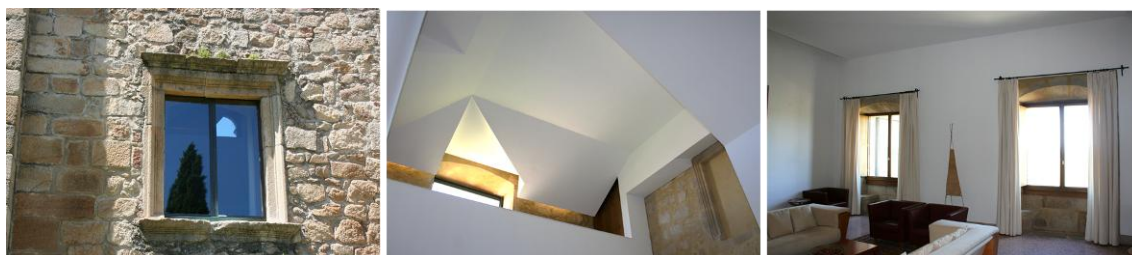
Pormenores de uma janela, do teto falso da sala da lareira e das janelas conversadeiras no interior do mosteiro.
